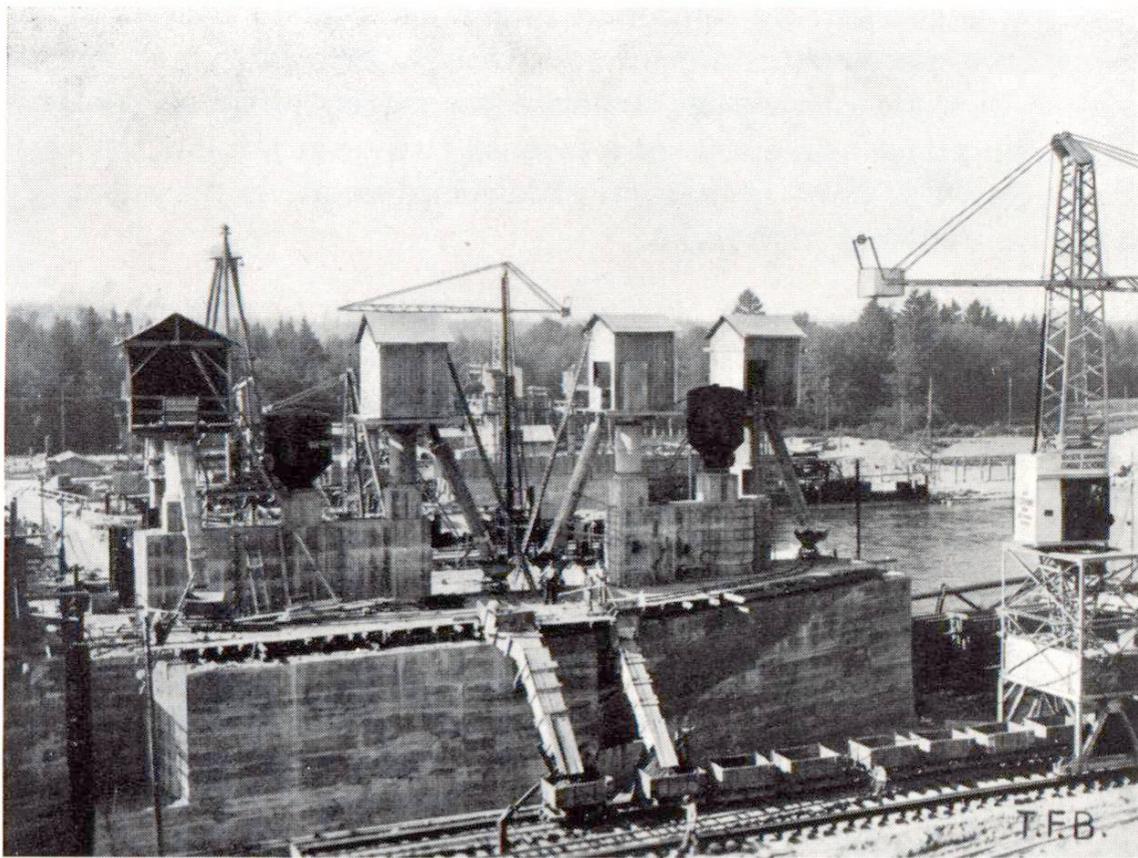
Fonçage d'un caisson en béton armé de la culée rive gauche du barrage
